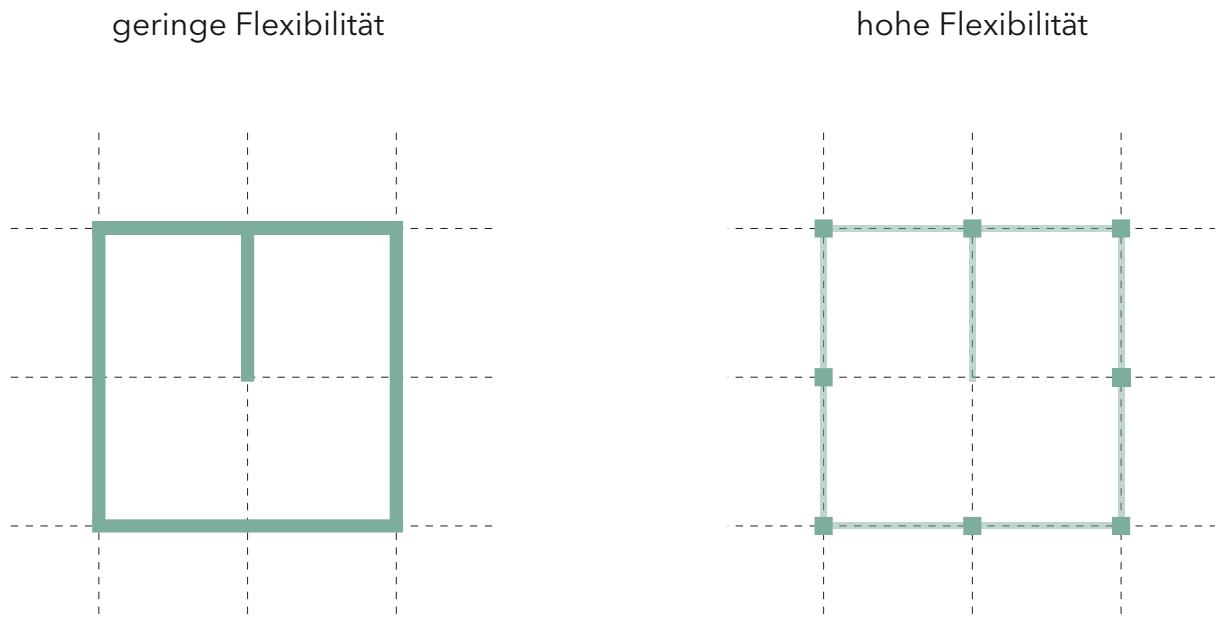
Vergleich Grundriss Massivbau zu Skelettbau
